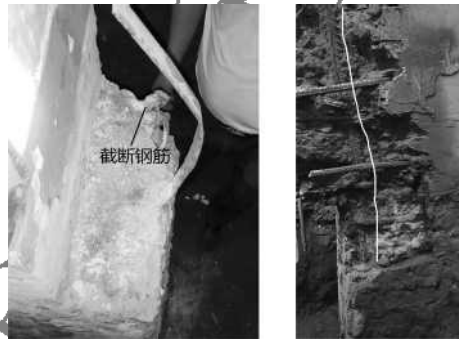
柱截面错位引起的竖向钢筋位置偏差案例图
